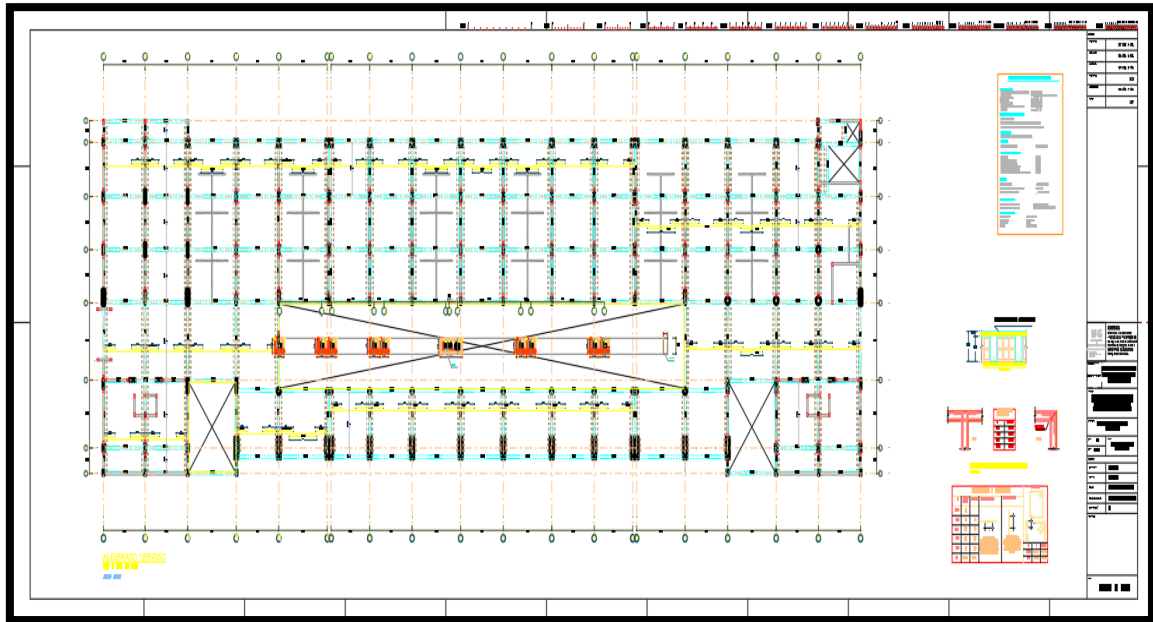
Se aprecia plano de estructura de techo, aligerado unidireccional.
